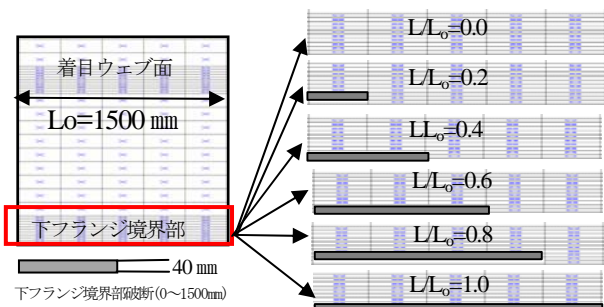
下フランジ境界破断モデル図(破断箇所拡大)
